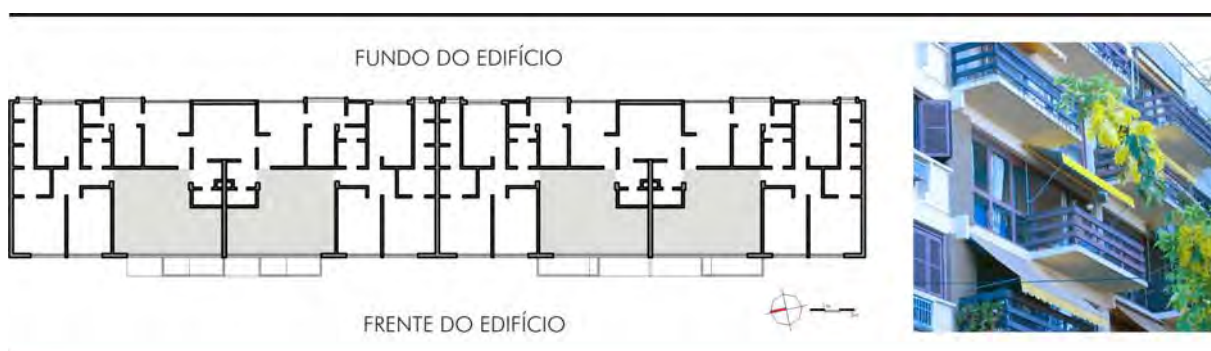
PLANTA DO PAVIMENTO-TIPO E VISTA DO EDIFÍCIO MONTE ARABELO
